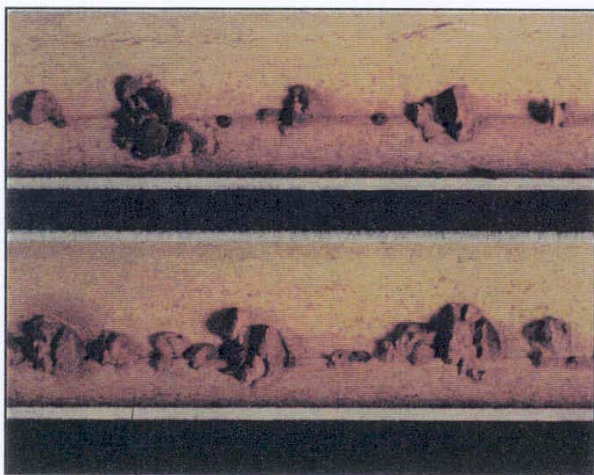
Muldenkorrosion an der Schweißnaht eines Rohres für Trinkwasser /6-4/
